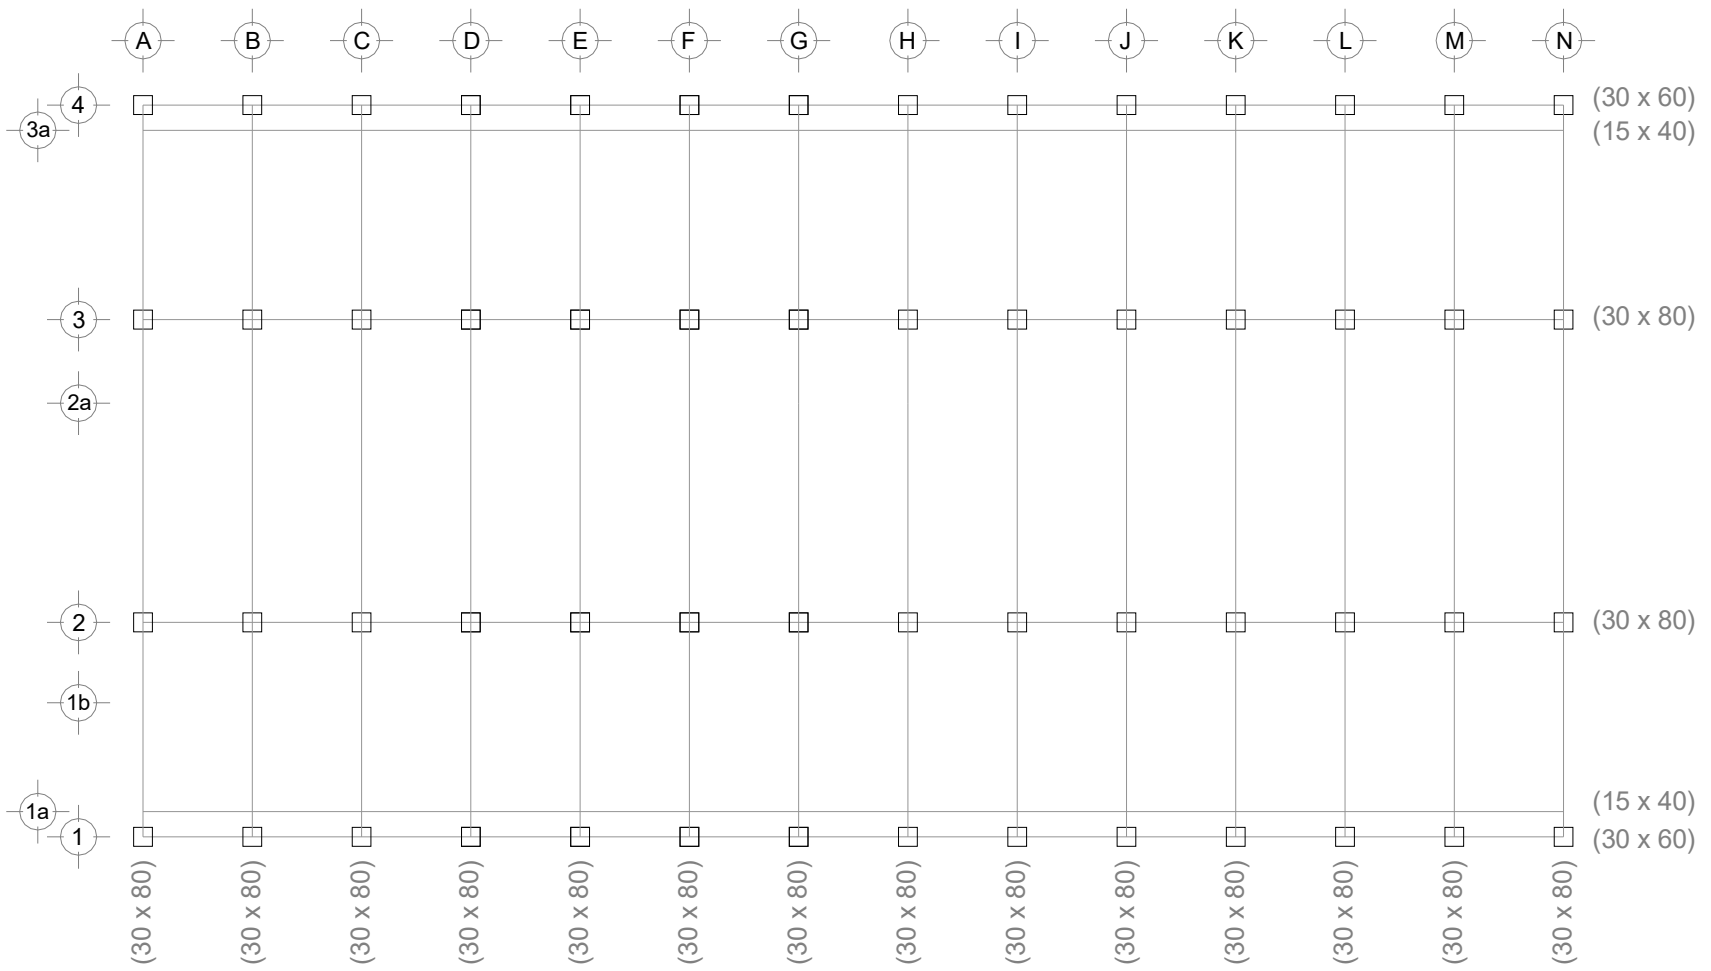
Planta estructural. Losa Nivel 04 a 09
